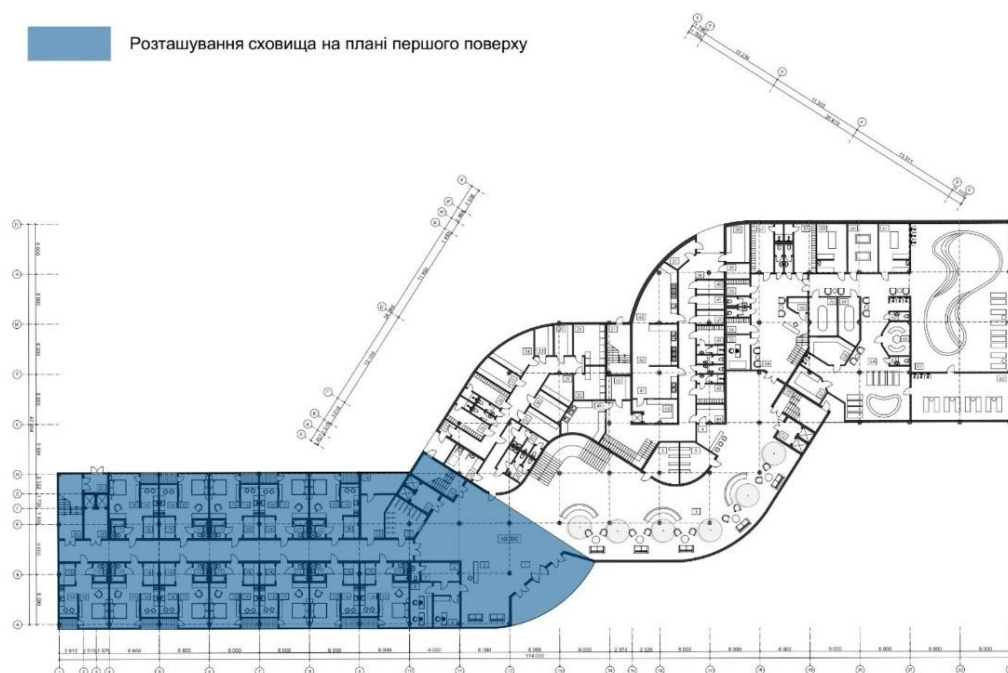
Схема розташування сховищ на плані першого поверху
